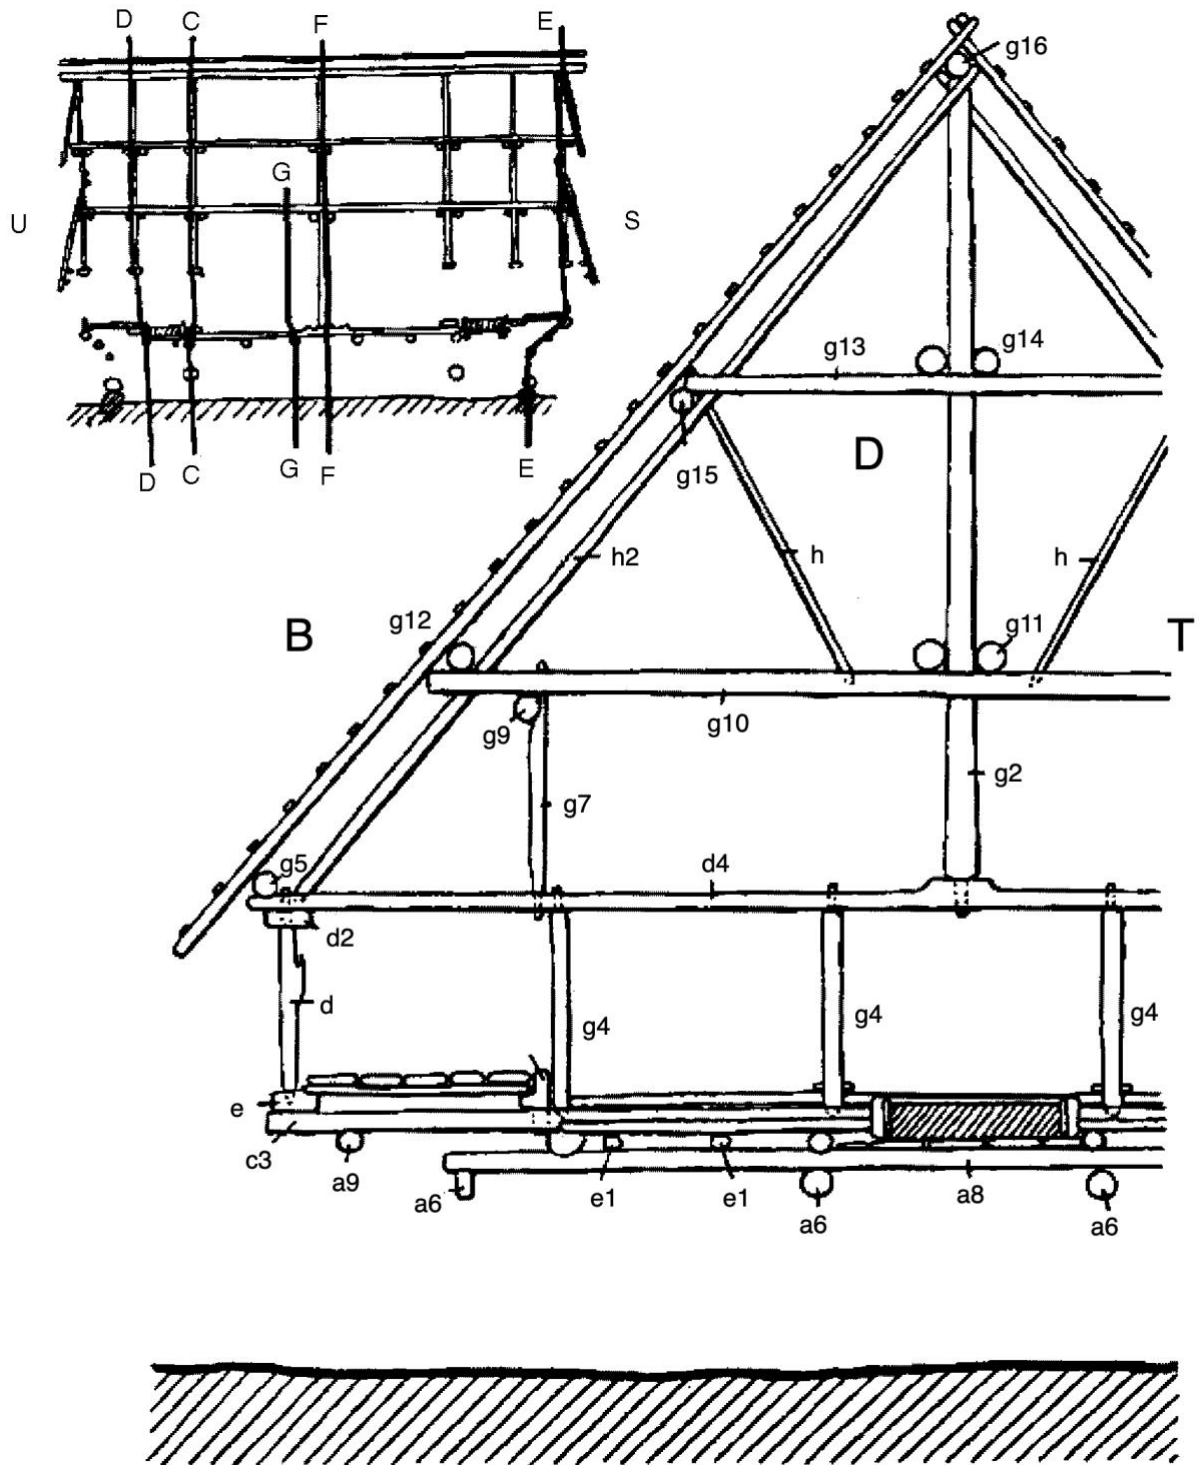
Kuil Kantewu. pondasi a1-a6; b: papan lantai; c-c2: rangka lantai; d, d2: dinding; e: palang membatasi anak tangga; g1-g16: rangka atap; h: penyangga miring yang menopang kasau; h1,
